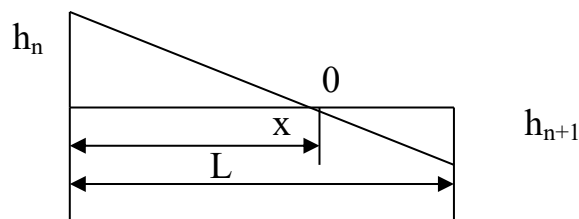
Схема к определению расстояния до точки перехода из насыпи в выемку и наоборот.
